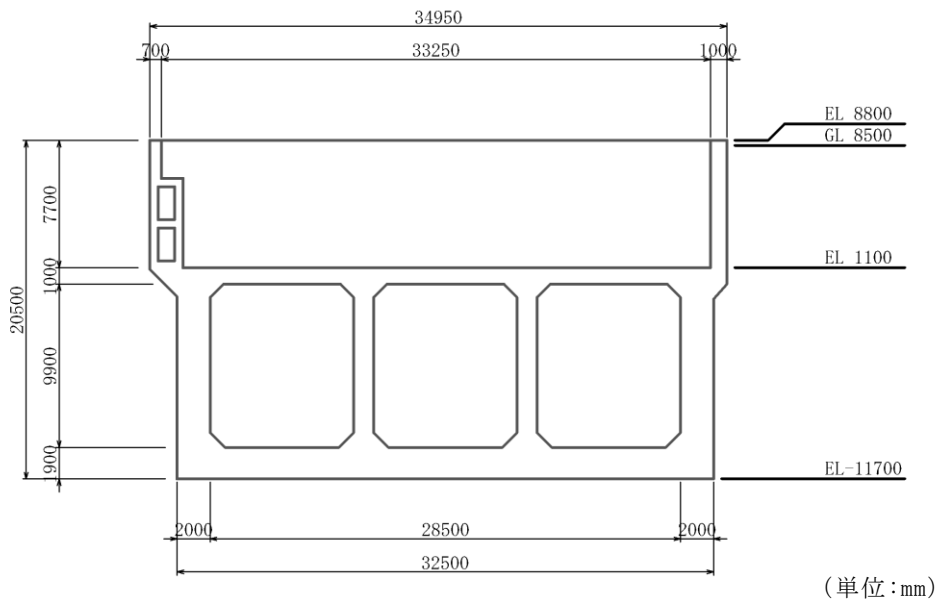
取水槽 断面図 (海水ポンプエリア (B-B 断面))
